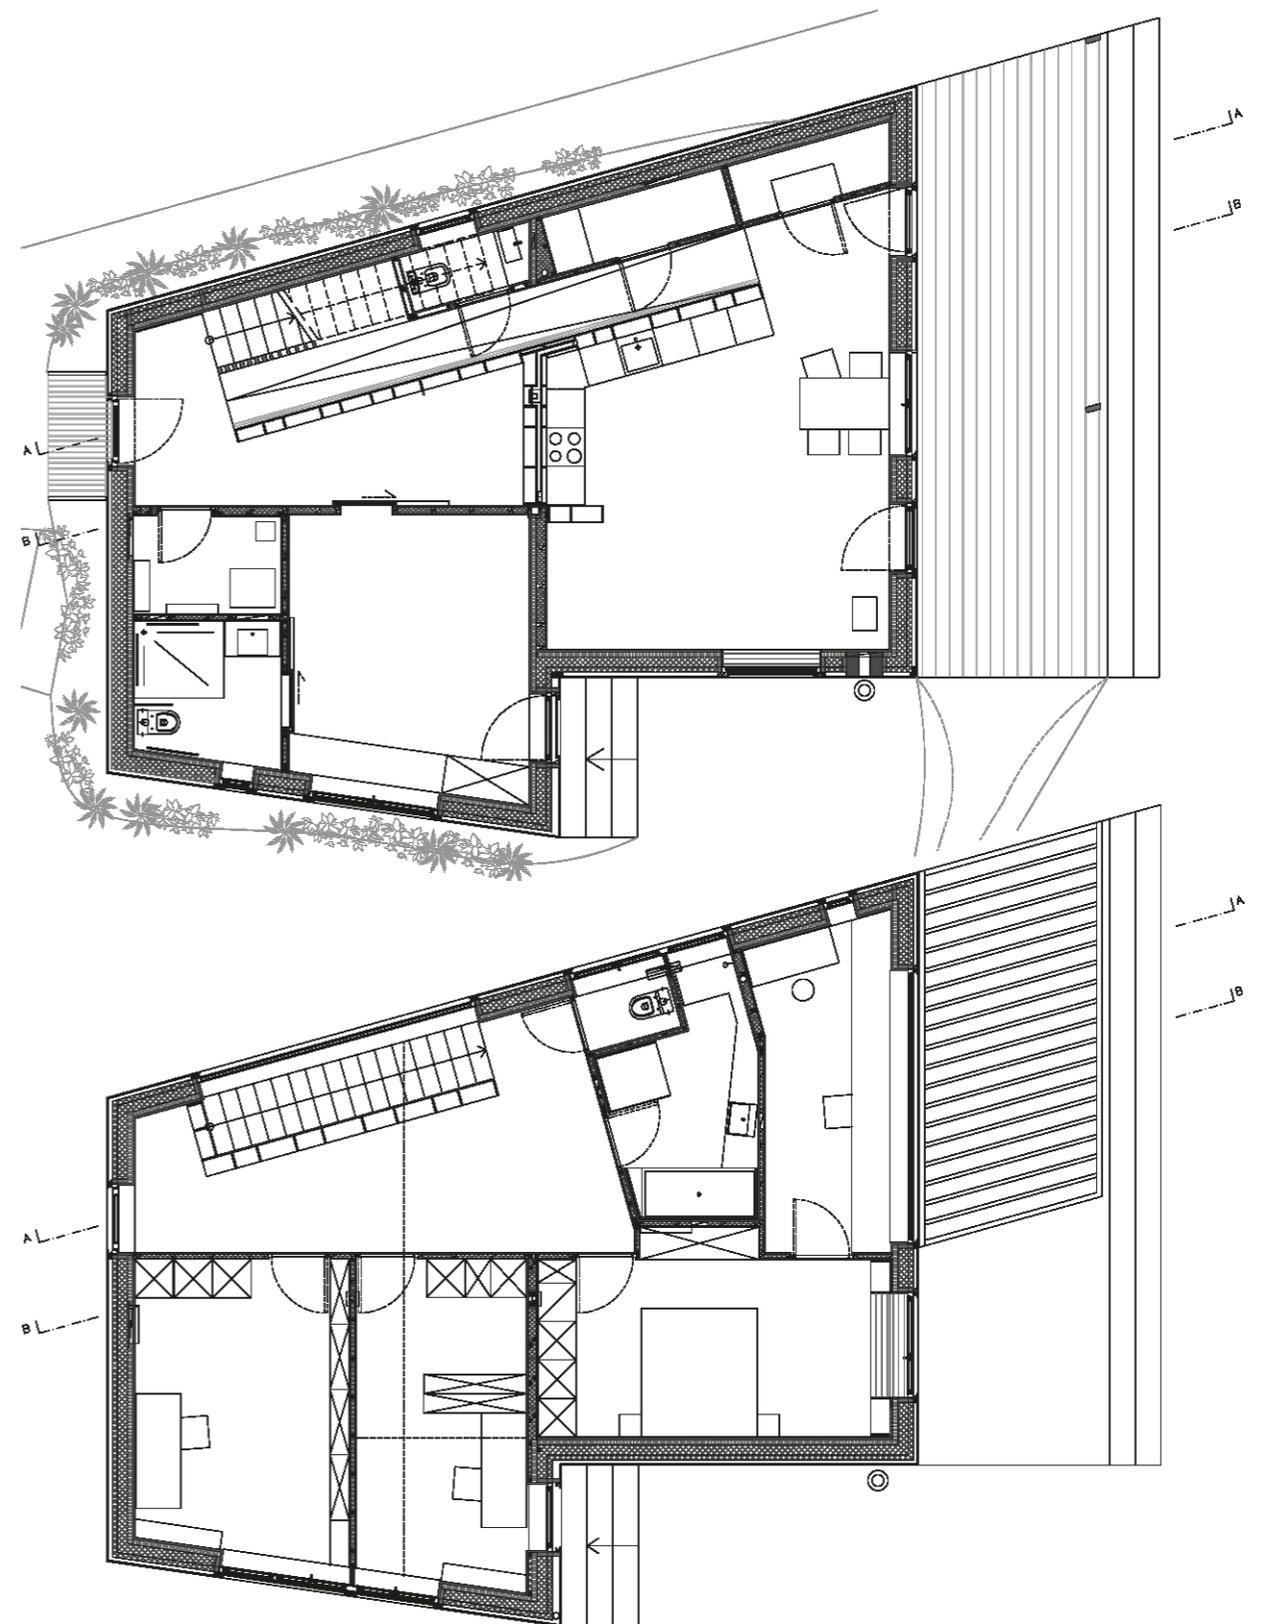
Haus ohne Beton, Grundriss EG
